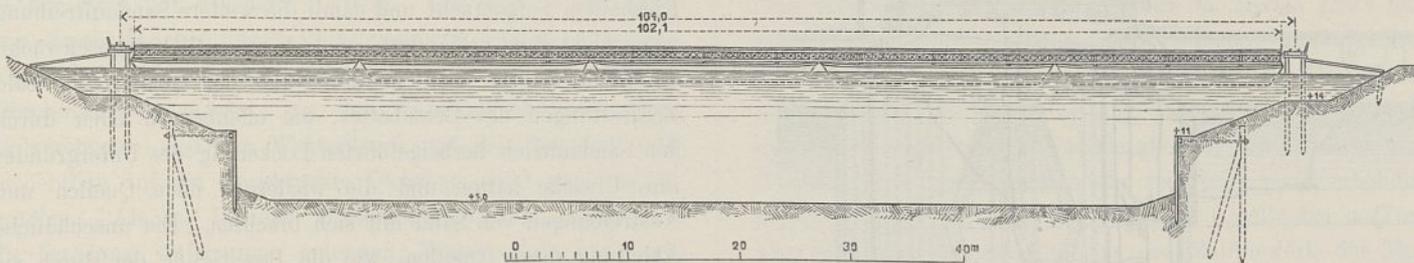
Querschnitt durch die Baugrube und Ansicht der Schwimmbrücke.
